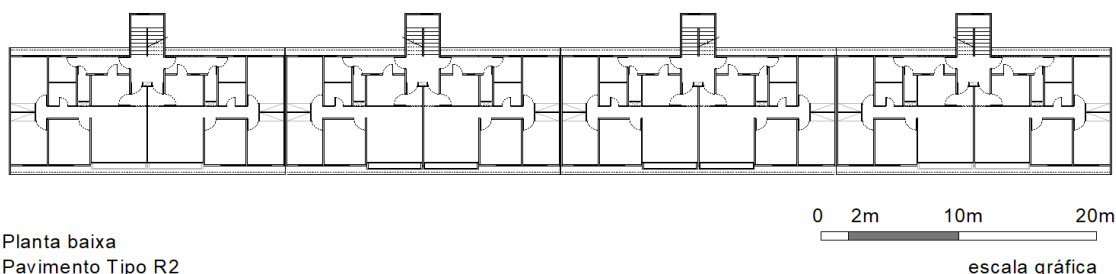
Planta baixa do pavimento tipo do R2. Fonte: da autora, adaptado das pranchas originais do Acervo do Arquiteto Milton Ramos.
